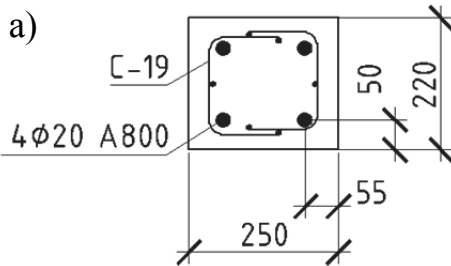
Примеры армирования нижнего пояса фермы:
